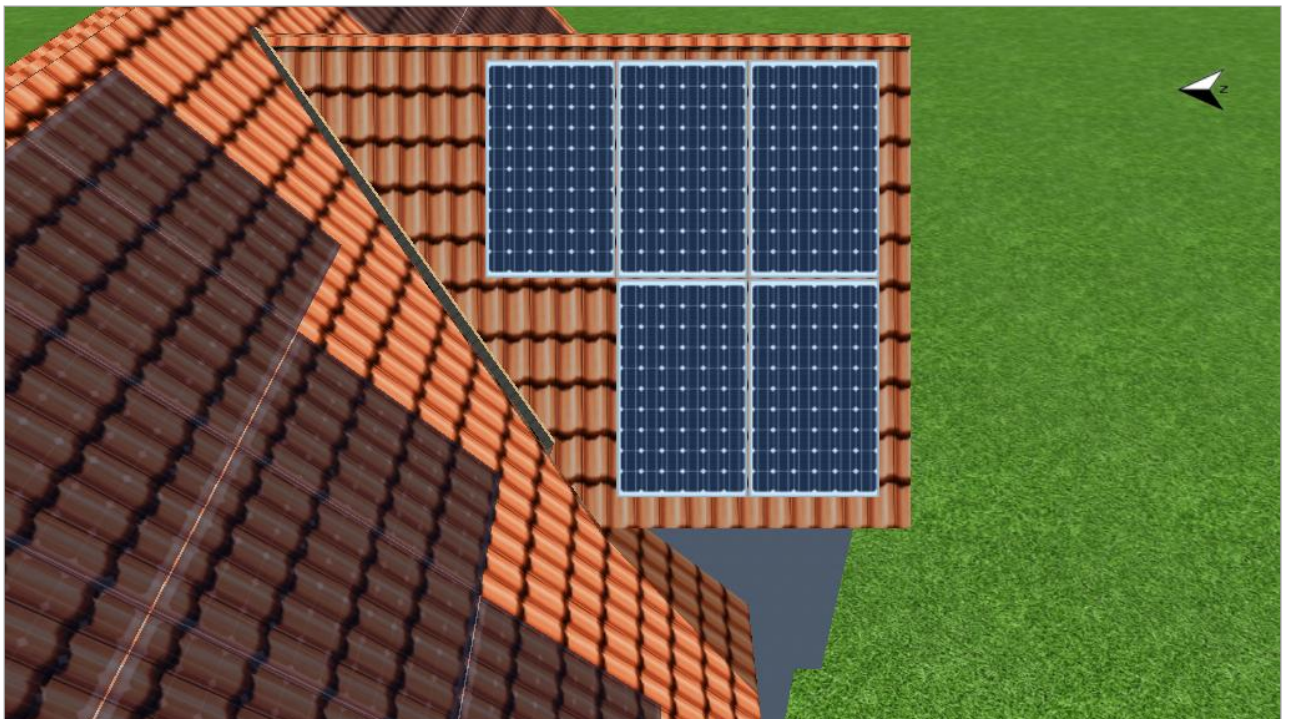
Modulfläche - Bay 1-Roof Area West
